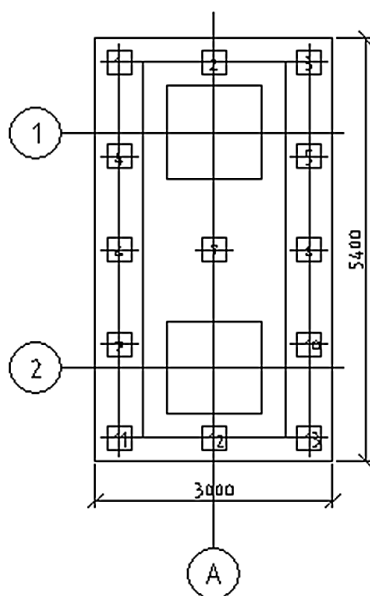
Схема конструювання пального куща (13 паль)
